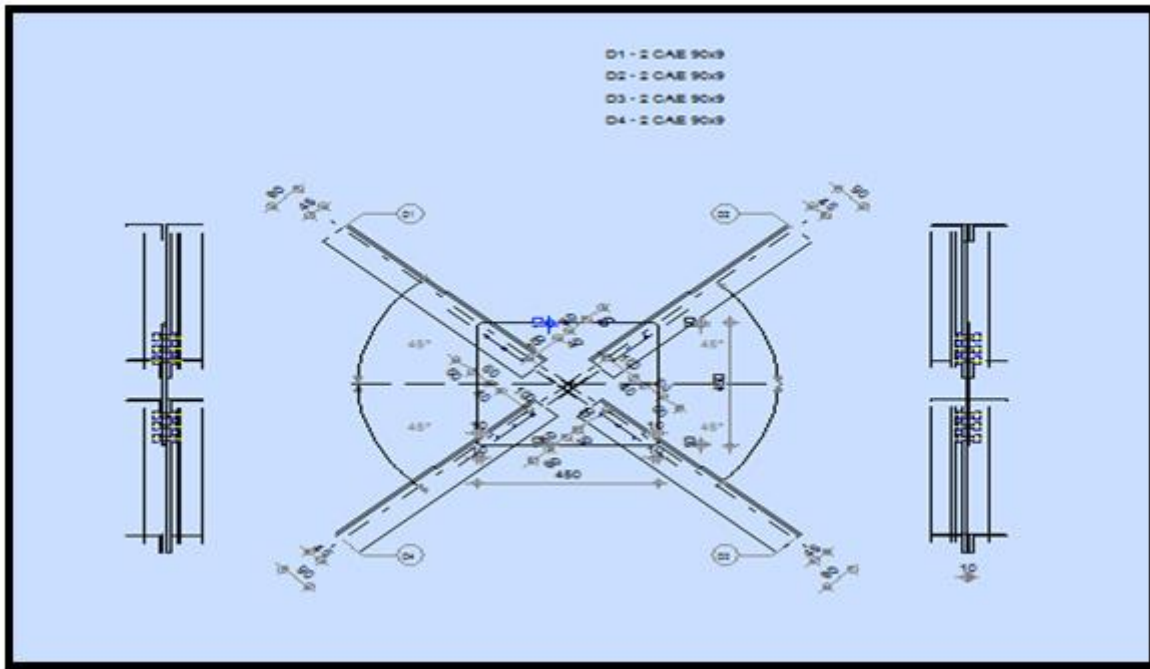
Vue en plan de l'assemblage des diagonales doubles cornières avec gousset
